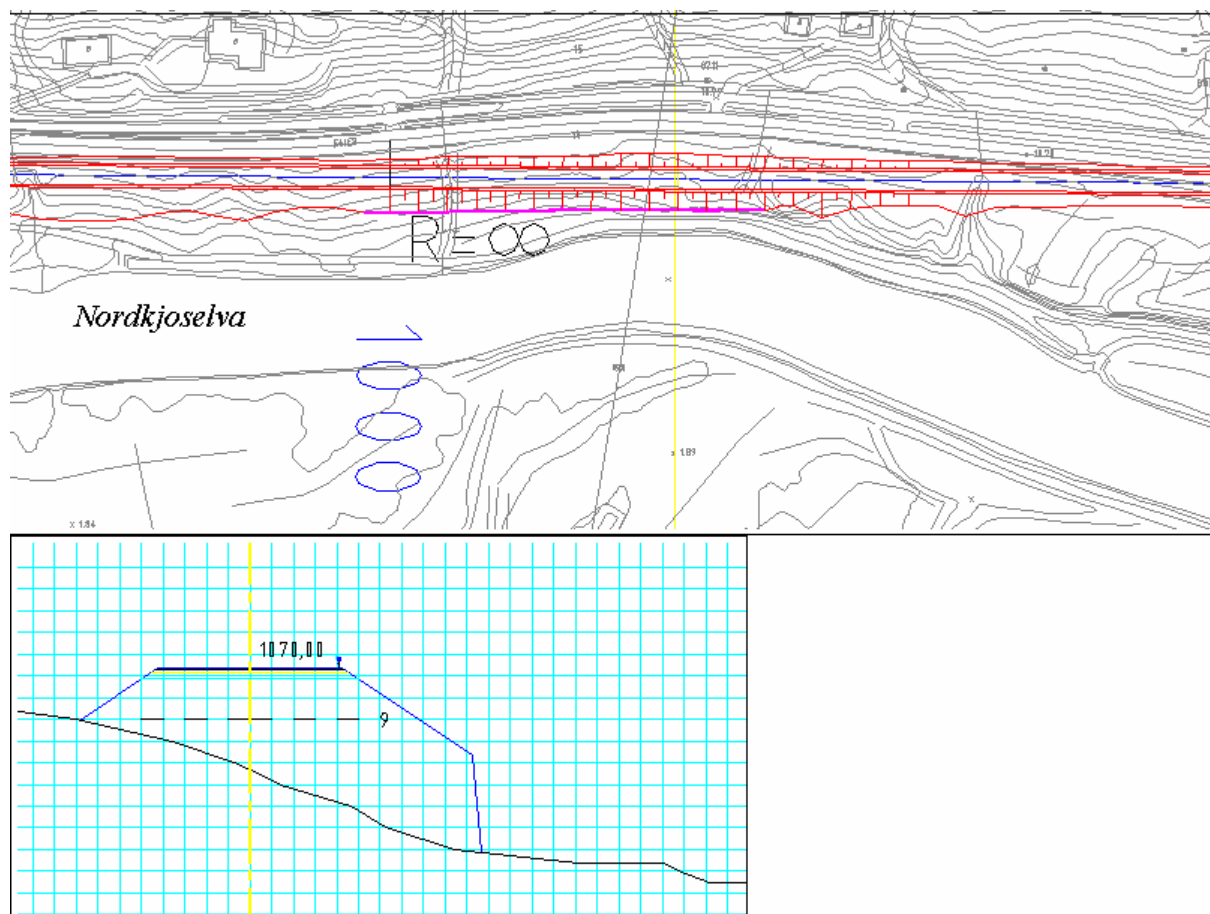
Avbøtende tiltak alt. 1 v/Nordkjosbotn pr. 1030-1130 - innstramming med 4,5 m høy tørrmur i 100 meters lengde -vist i plan (lilla strek) og typisk tverrprofil (pr. 1070).
